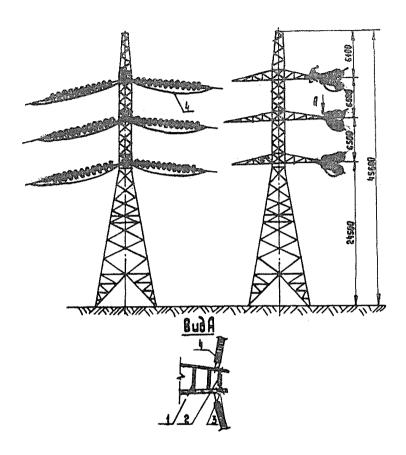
Опрессовка проводов в шлейфах анкерно-угловой опоры У-220-2+14:
